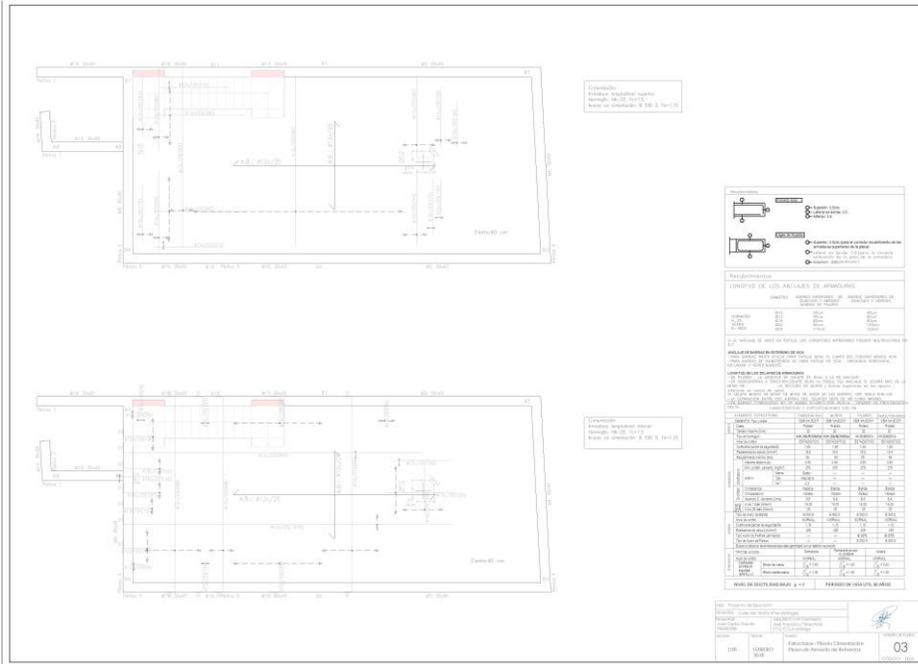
Plano de Armado de Refuerzos, Cimentación.
